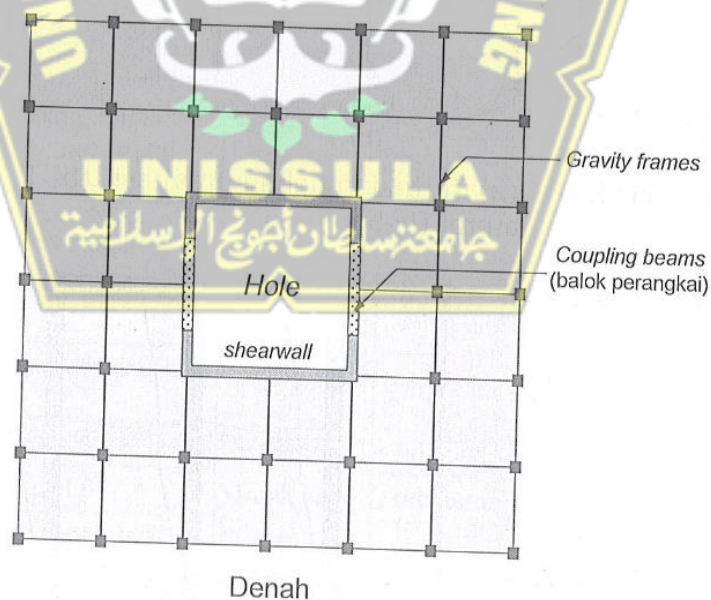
Portal Balok- Kolom penahan beban lateral
